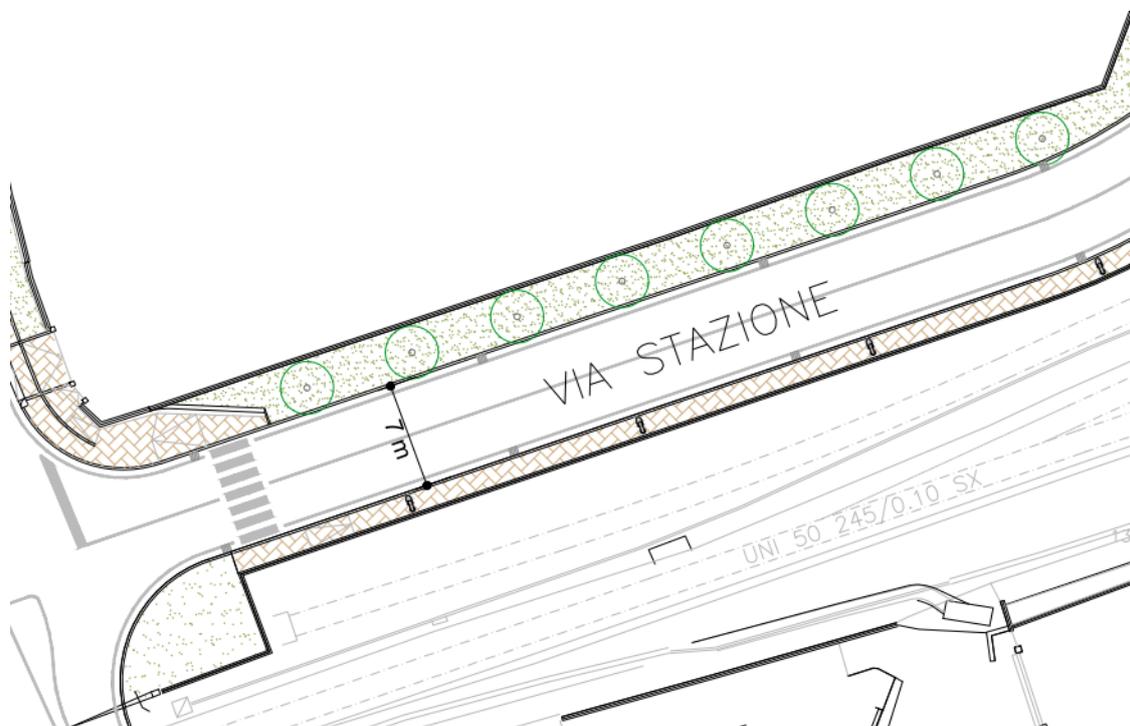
Dettaglio del progetto di riforma del primo tratto di Via Stazione
